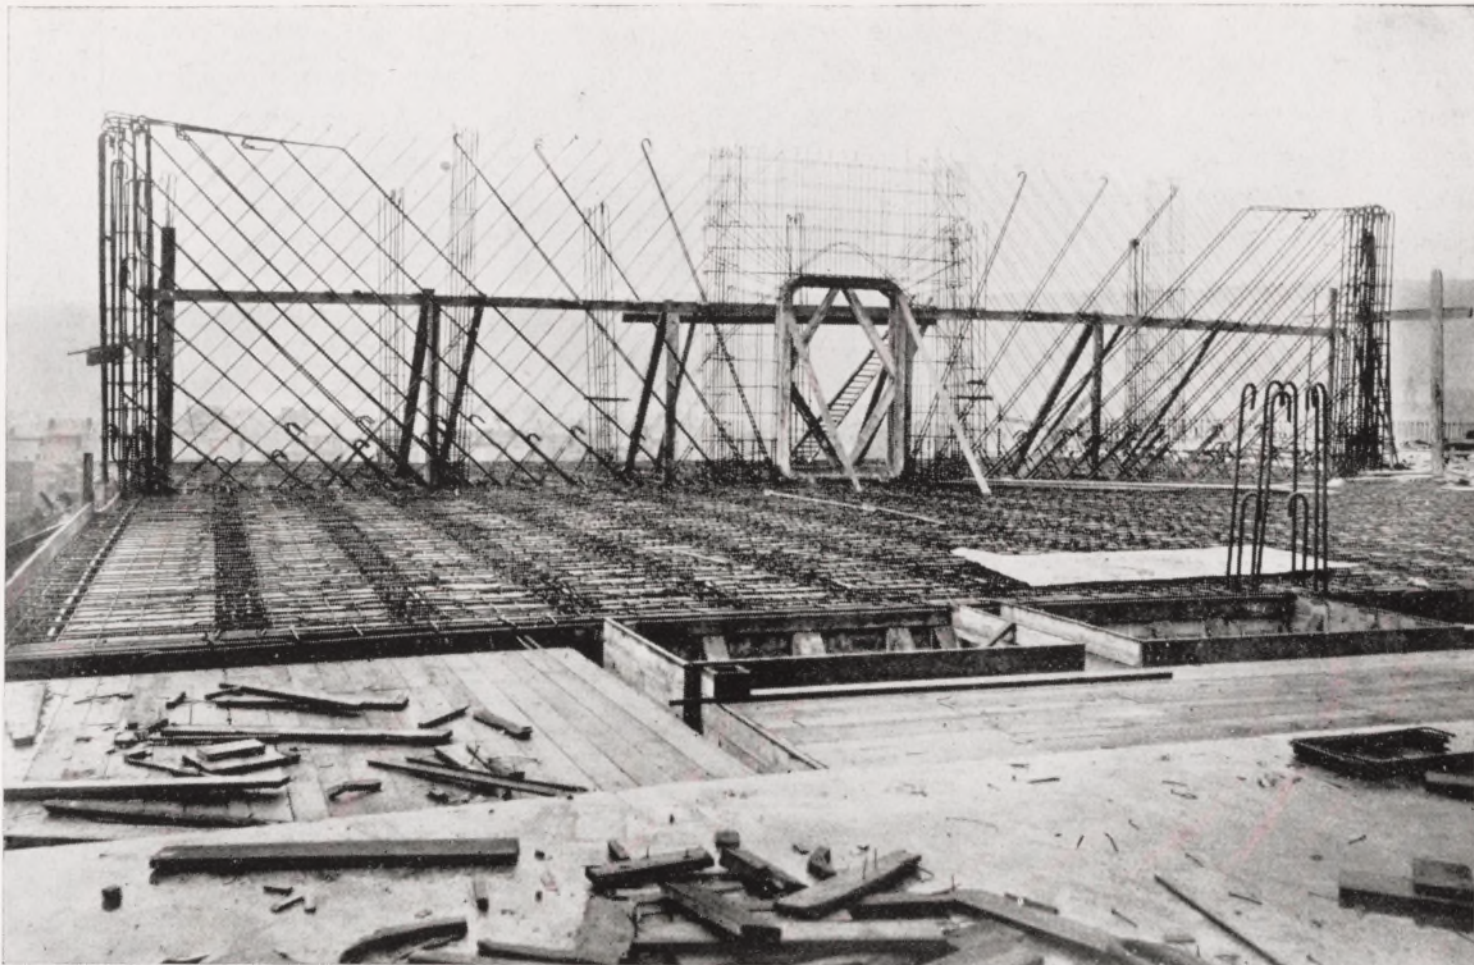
Armature de la poutre en béton armé de 20 mètres de portée, à évidement central.
